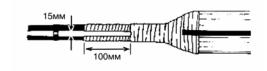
Обмотка разветвлений лентой ВМ.
